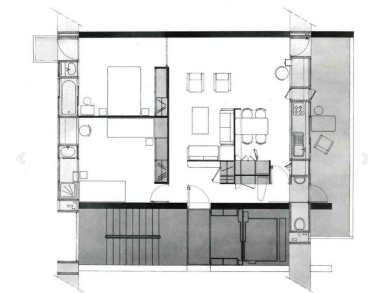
Planta de um apartamento tipo. Concentração das águas nos corredores laterais.
